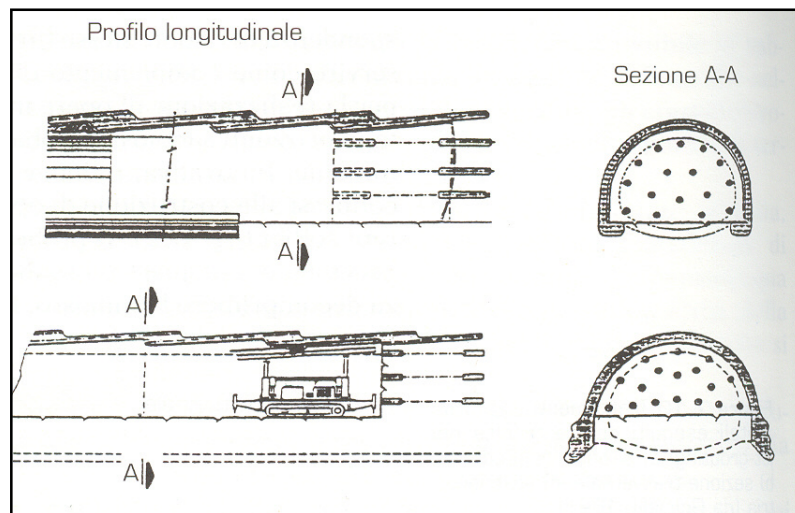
Precontenimento del cavo mediante jet-grouting suborizzontale (ANAS 1993).
